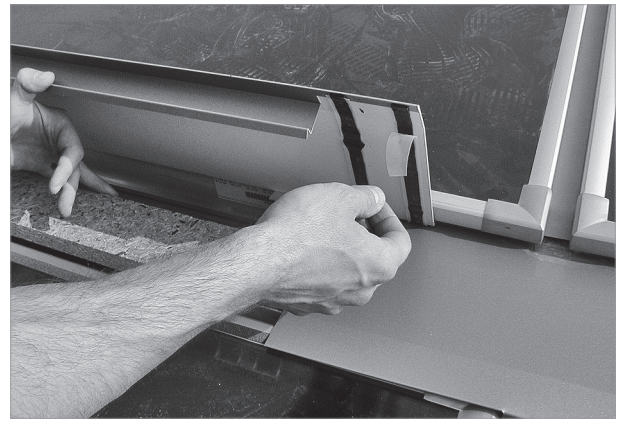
Montage d'autres tôles : retrait des bandes de protection avant la pose
